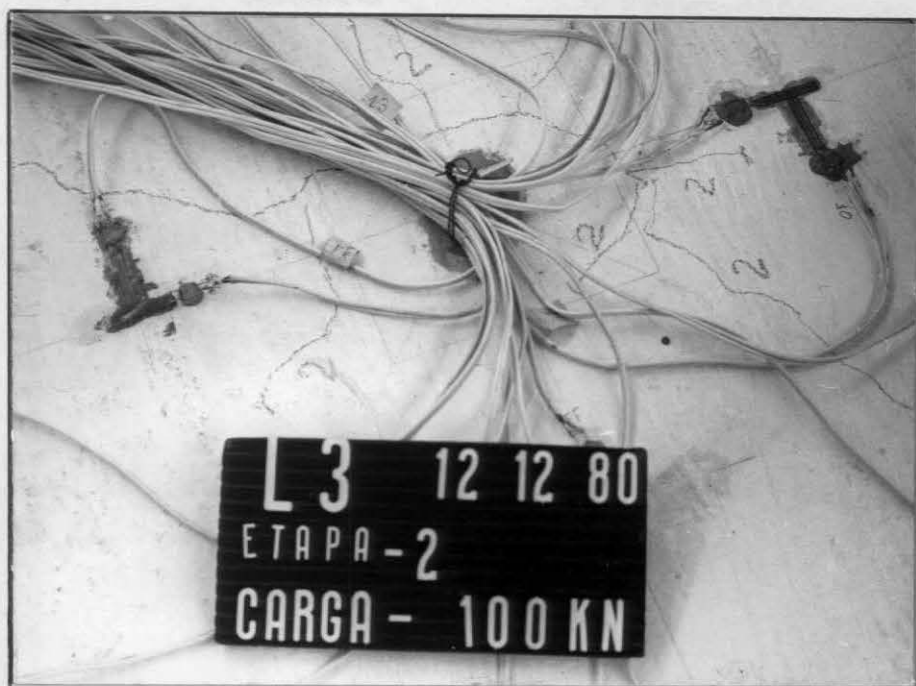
Configuração das fissuras - laje L3
